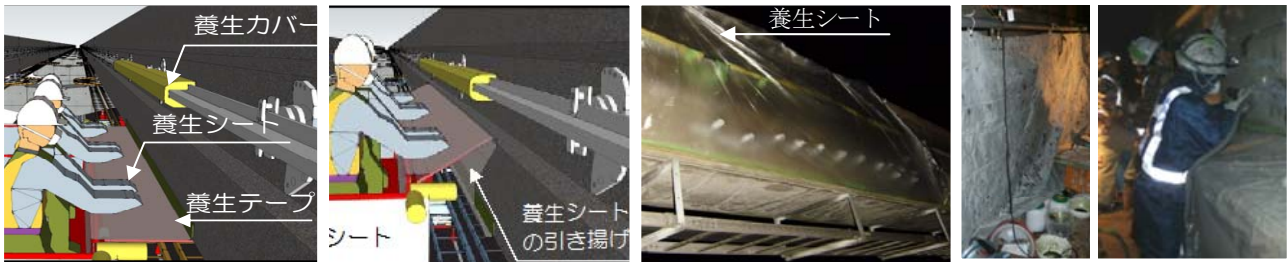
養生状況 図-10 養生移動 写真-4 注入後養生状況 写真-5 ケレン撤去状況
